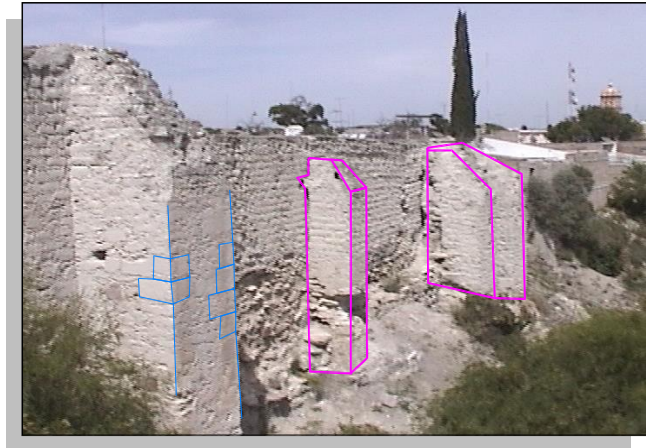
Vista de los contrafuertes ubicados en la colindancia sur junto al arroyo de la Hacienda del Refugio donde se observa el sistema de construcción empleado
